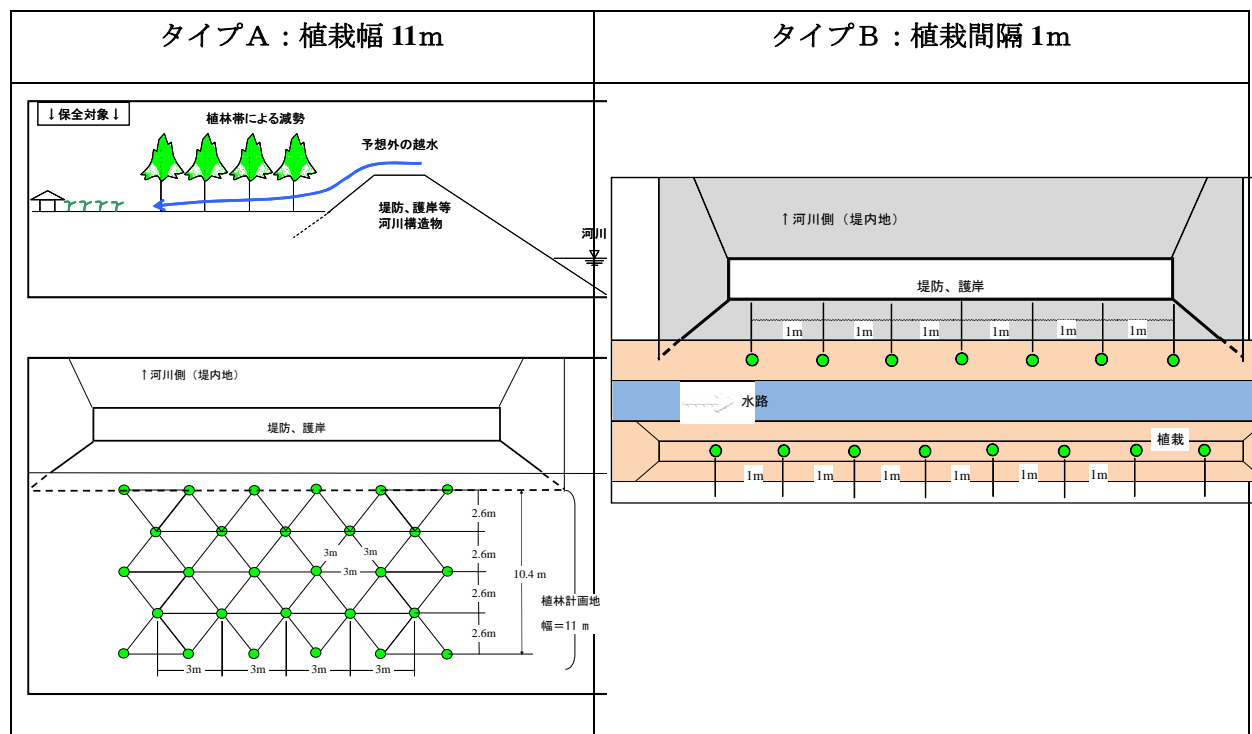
河川構造物沿いの植林概念と配置図 (タイプA、B)
